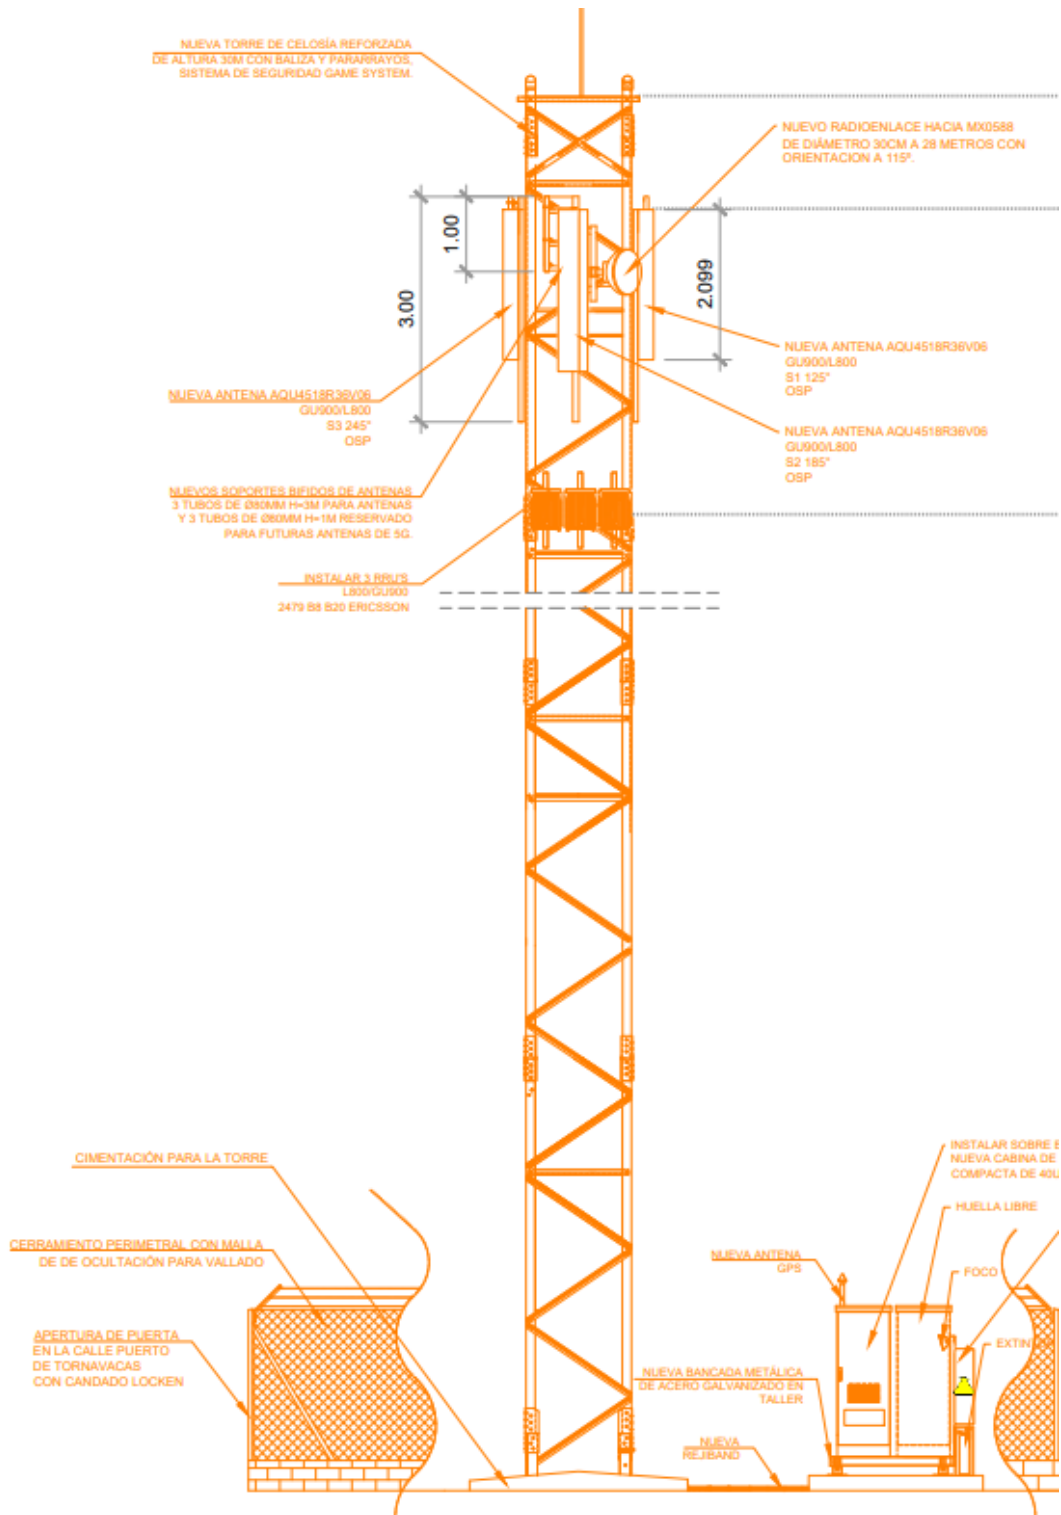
Distribución del emplazamiento alzado. Elaboración propia.
